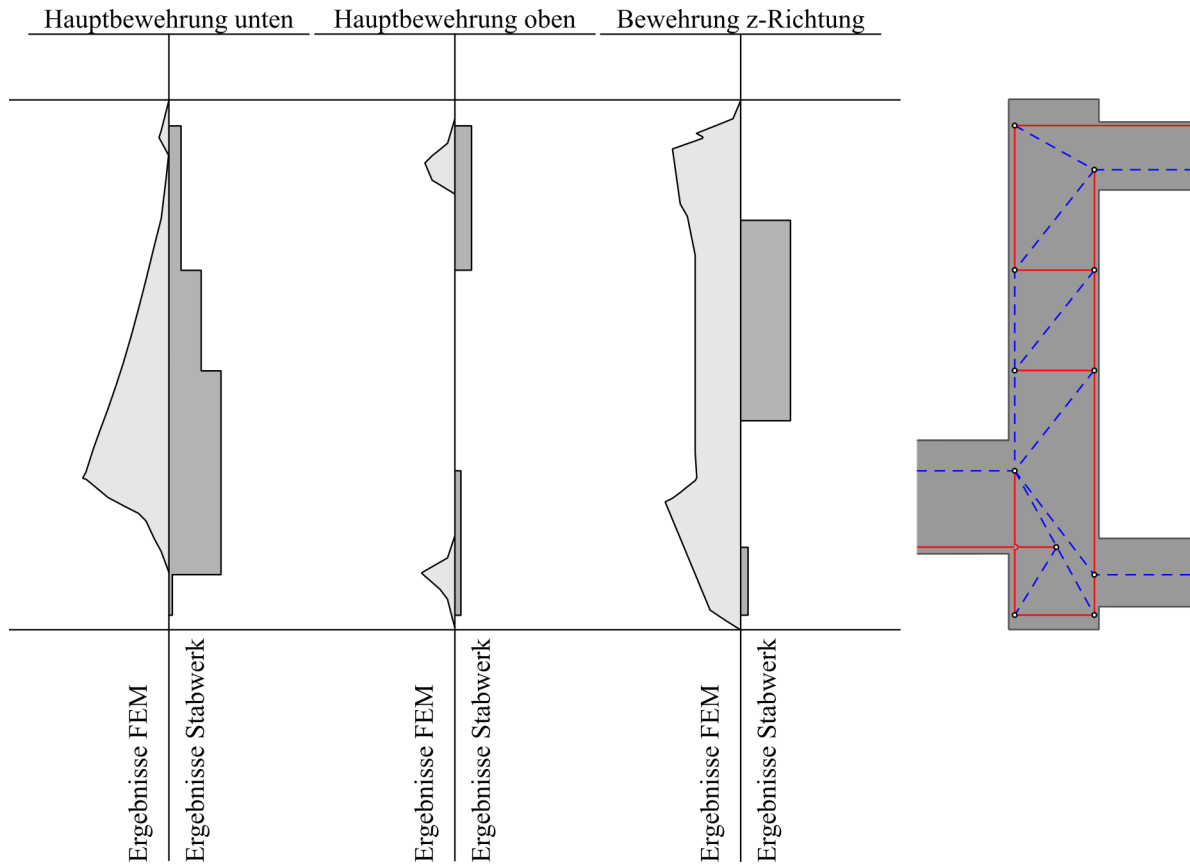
Variante 3 Lastfall 2 - Bewehrungsvergleich
